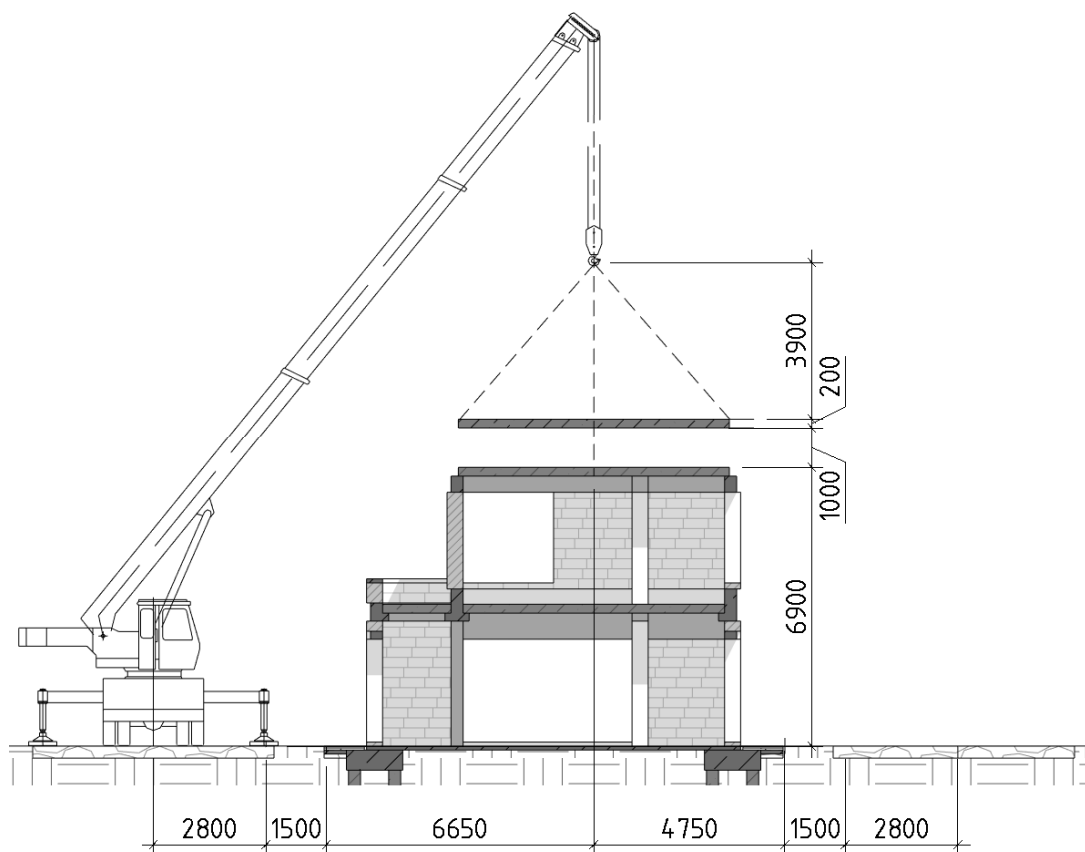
Схема розміщення крану для монтажу плити перекриття
